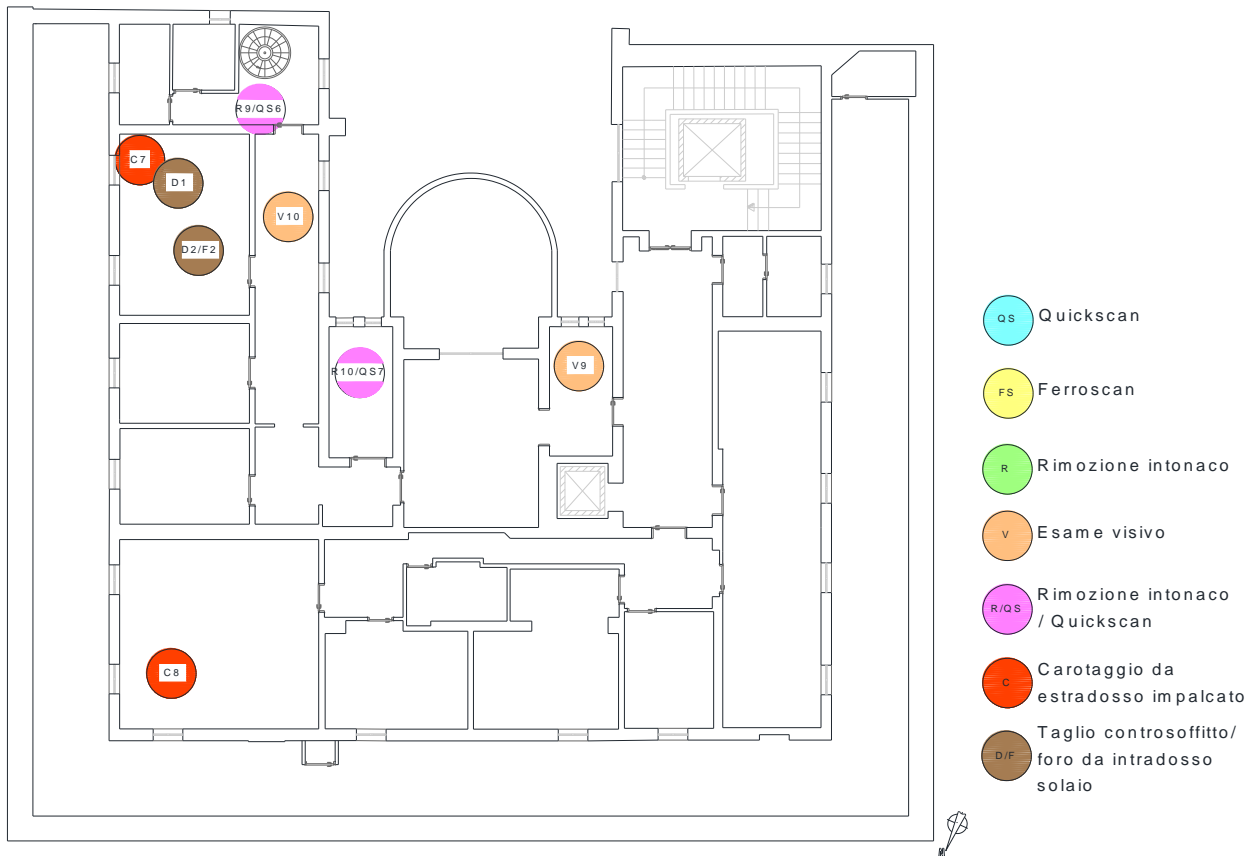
Pianta chiave con indicazione dei punti di sondaggio sui solai ai piani secondo e terzo.
